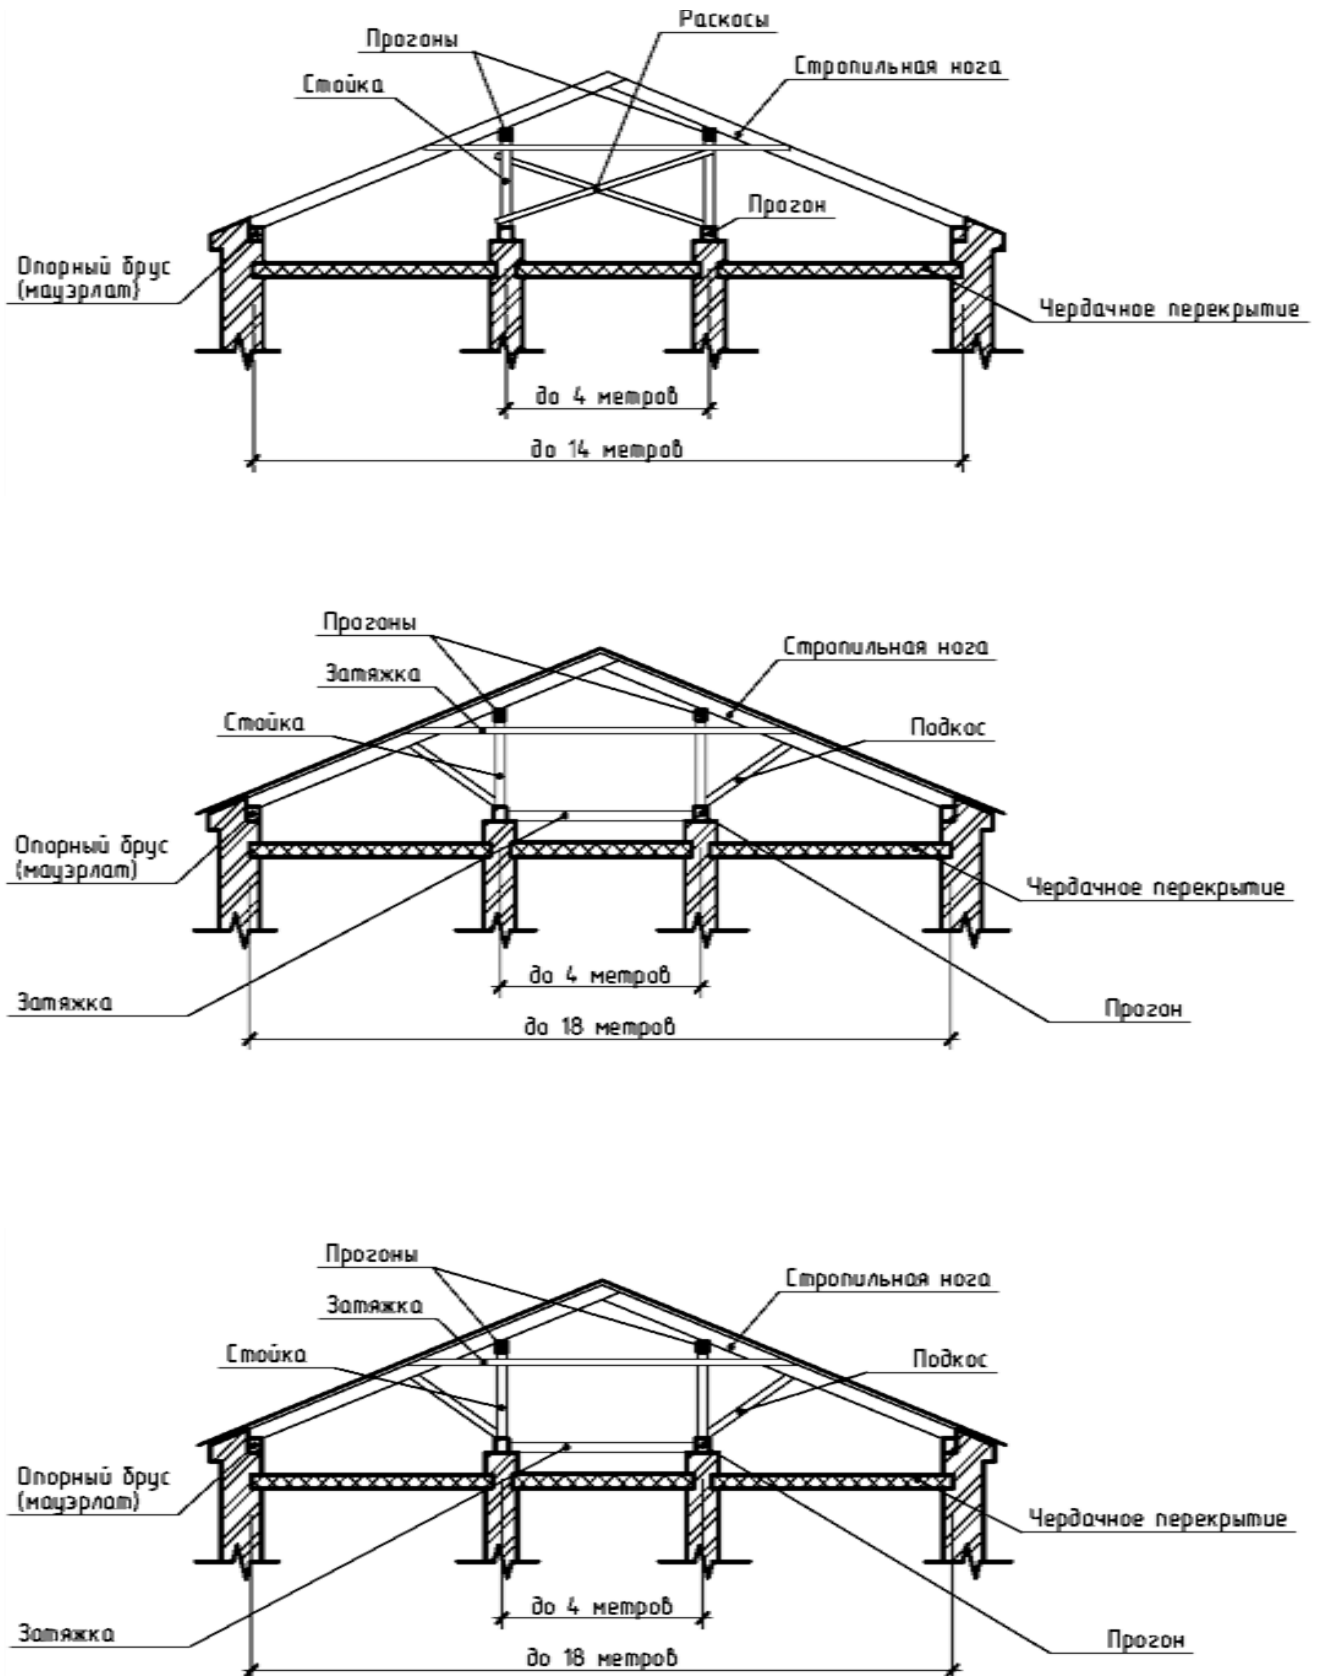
Варианты устройства стропильных конструкций в крышах домов с двумя внутренними несущими стенами
